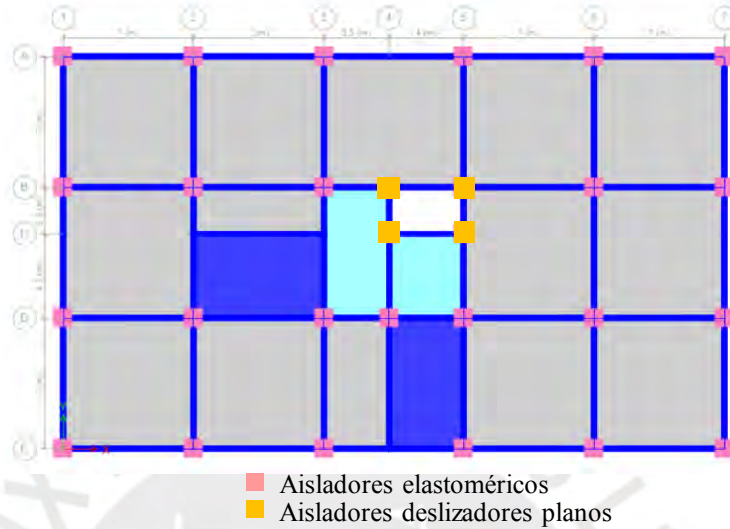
Vista en planta de la distribución de aisladores en la plataforma de aislamiento
